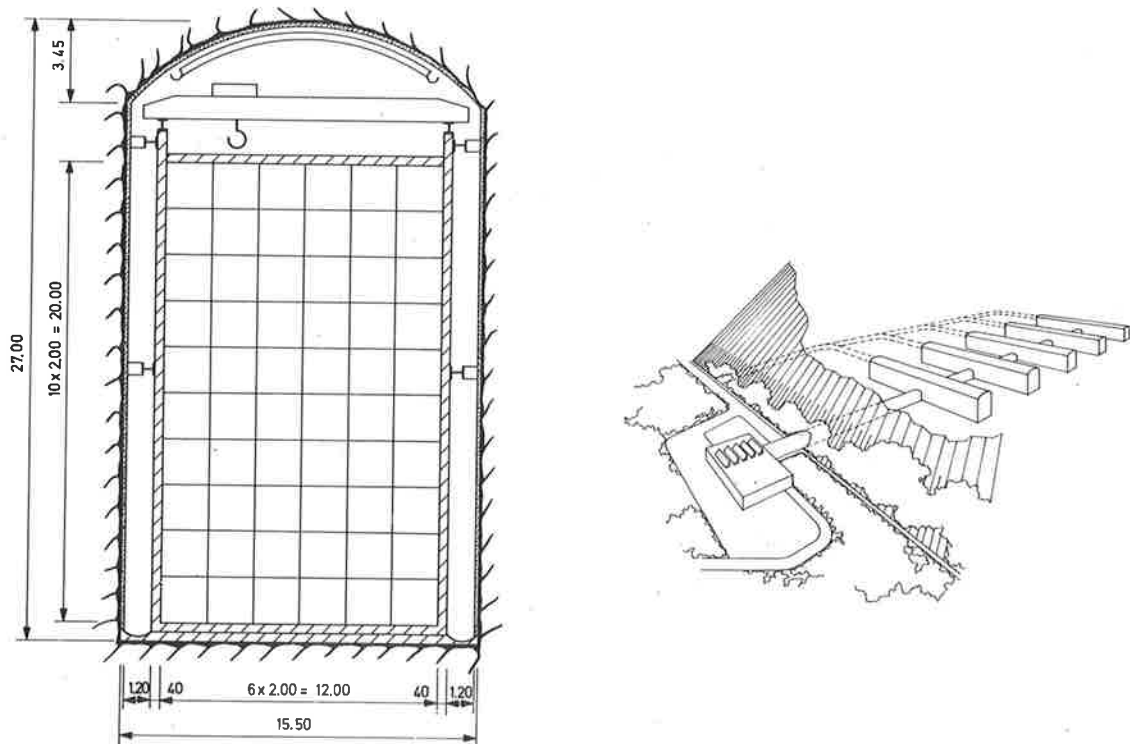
VARIANTE 8 / Coupe transversale et ensemble
